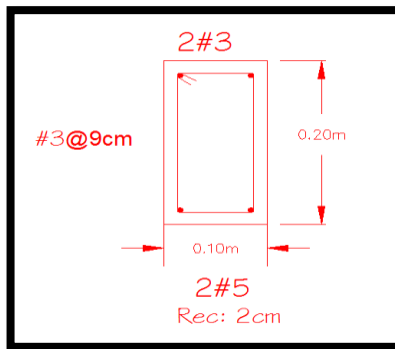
Perfil de viga A de escalera con distribución de acero de refuerzo.
